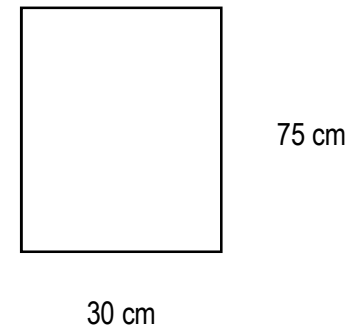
Croquis en planta de superficie de zapata a desarrollar [Ilustración]
